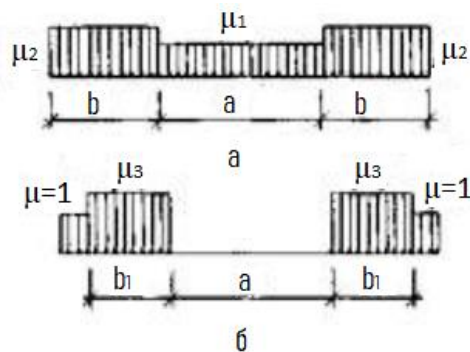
Схема 3. Будівлі з поздовжніми ліхтарями, закритими зверху:
